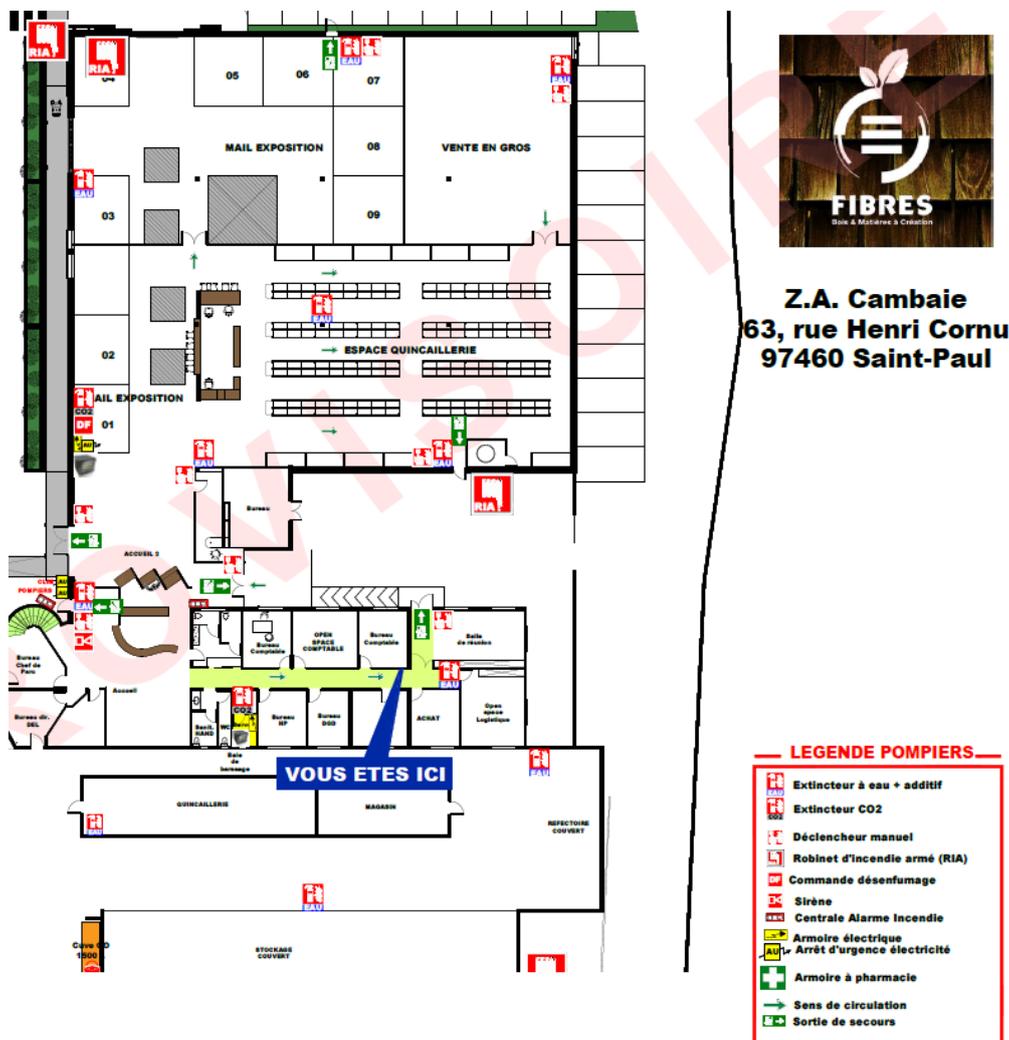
Plan d'évacuation de l'espace quincaillerie
